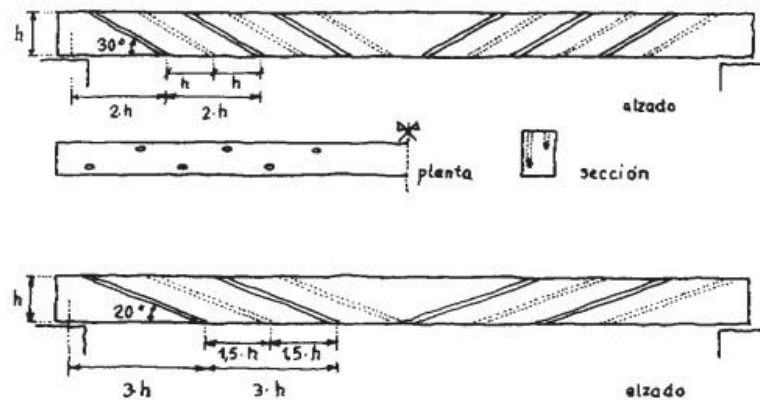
Refuerzo frente a una viga llena de fendas. Arriaga Martitegui, Francisco. *Intervención en estructuras de madera*.
